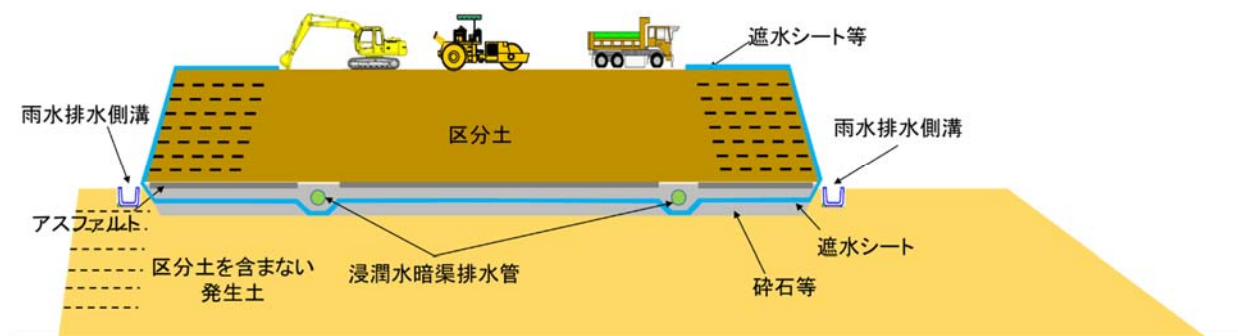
(1) 主な施工手順（アスファルト舗装施工）
